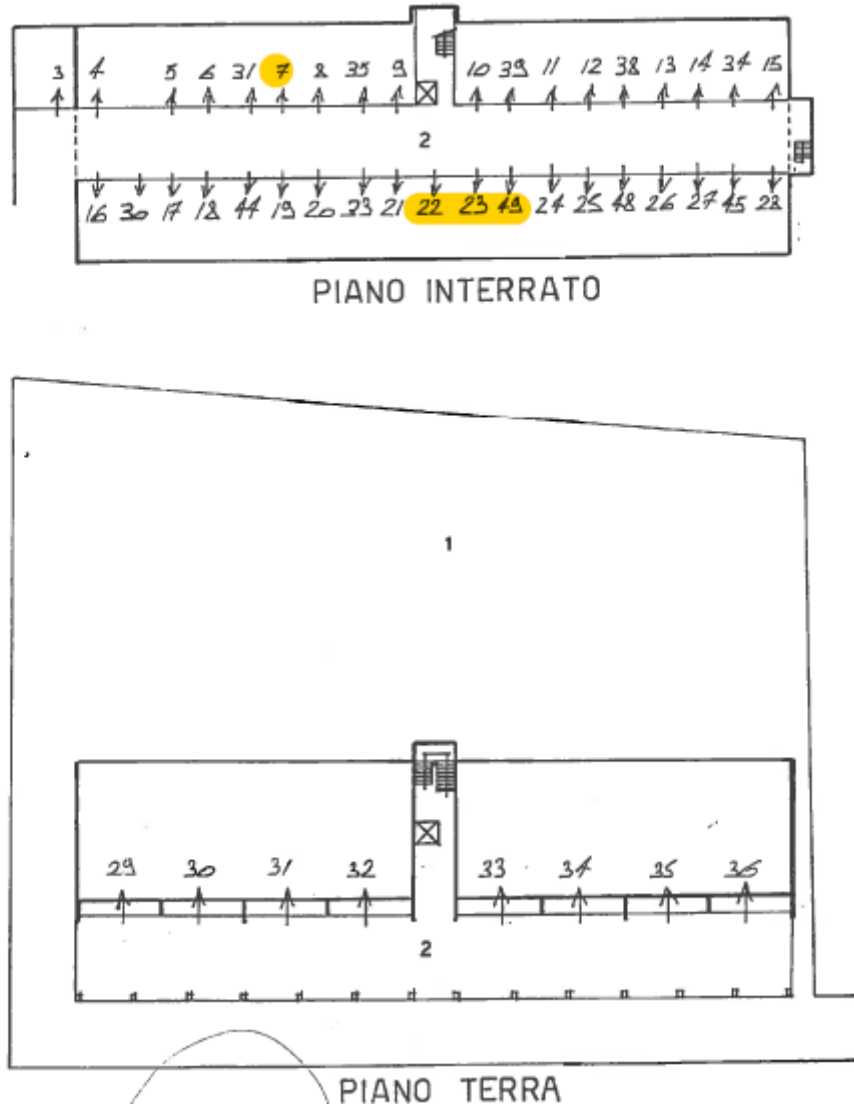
stalcio di elaborato planimetrico fuori scala NON presente in atti
